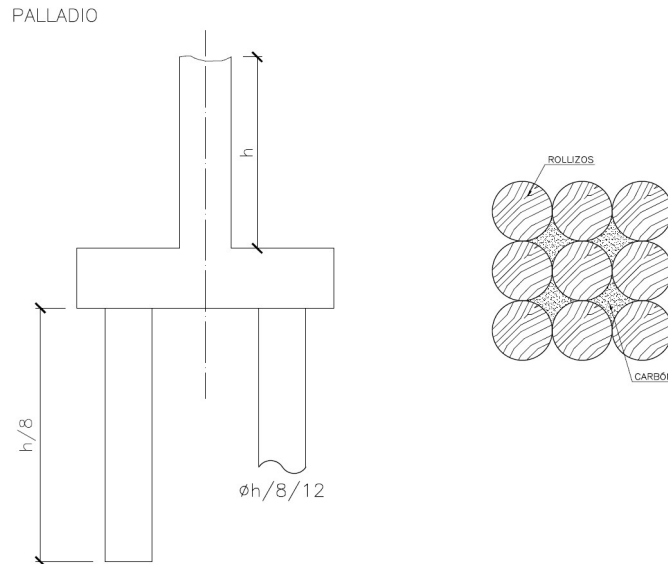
Tablestacado en Cimentación Profunda Según Palladio
